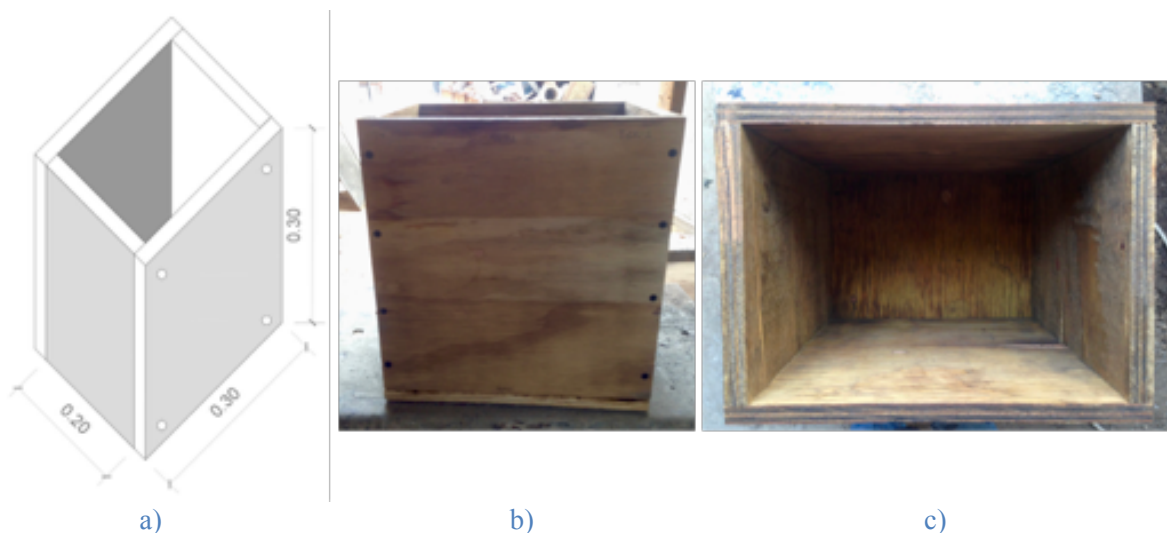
Molde para bloques de tierra compactada; a) diseño de molde; b) vista frontal y c) vista interior.
